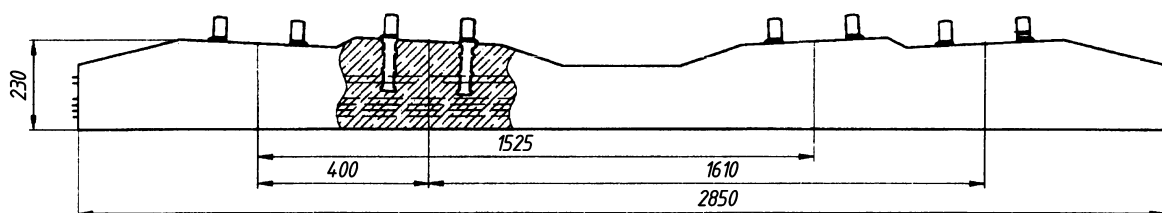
Залізобетонна шпала типу Ш 2С-1
